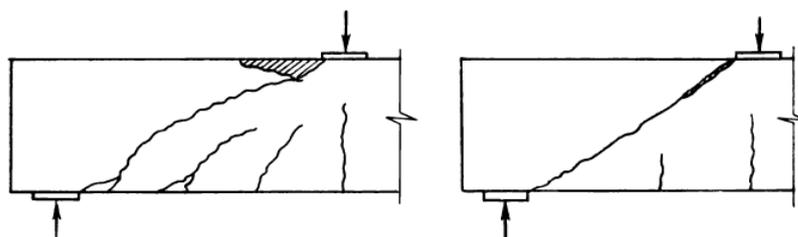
Виды повреждений вследствие разрушения бетона сжатой зоны [1]
